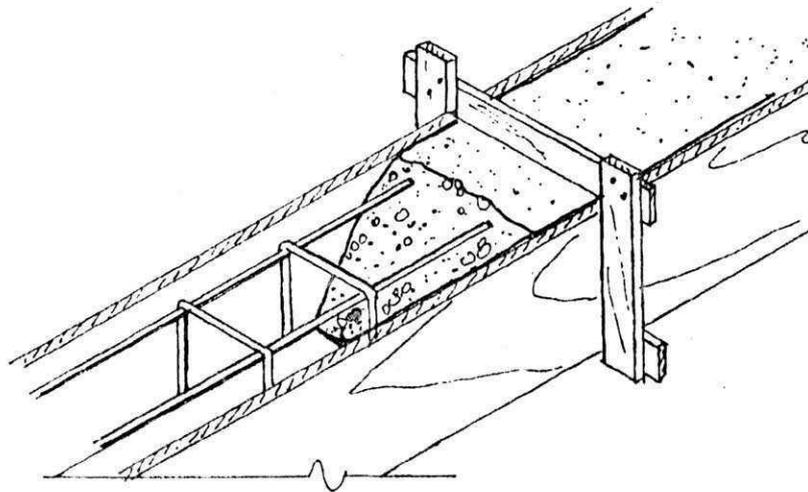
Emendas de concretagem em vigas realizada à 45°
